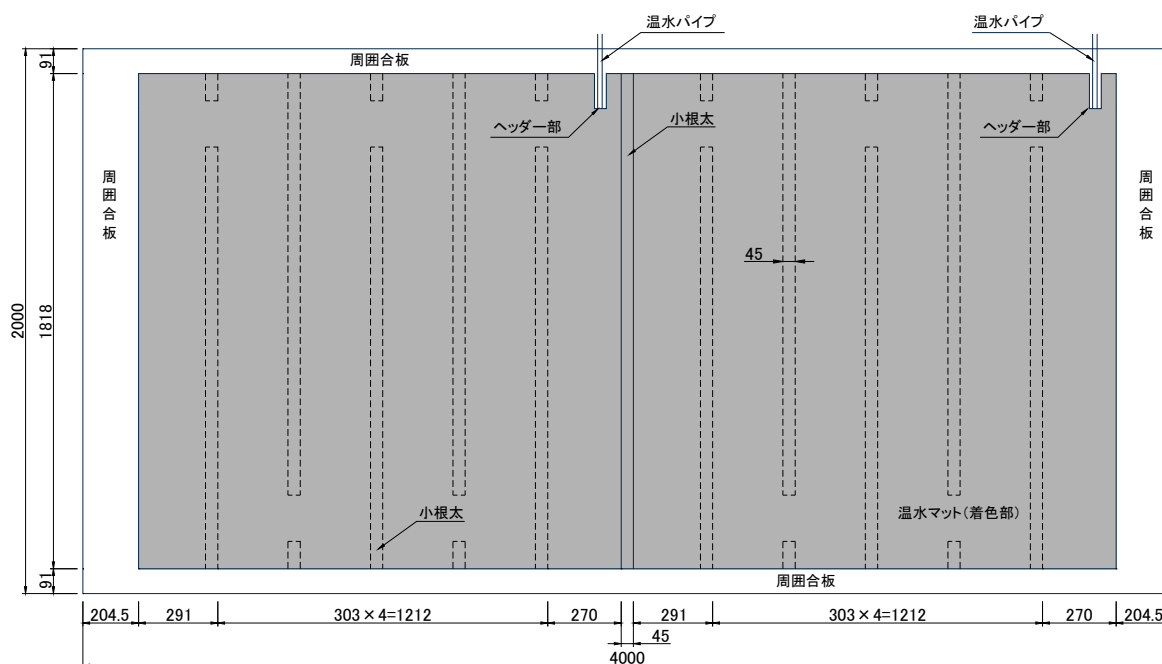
試験体図（温水マット配置図、施工時に確認） 単位：mm
